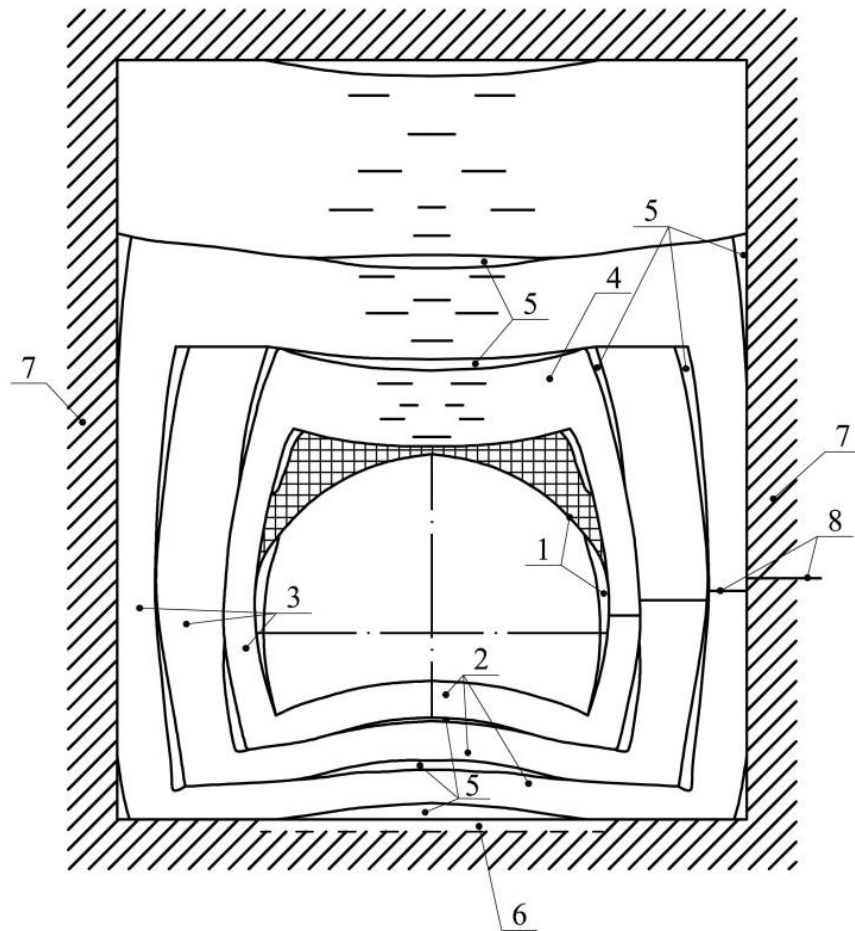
Схема деформирования пород приконтурного слоя и образования зон разрушения: 1 - металлическая арочная податливая крепь; 2 – породы почвы; 3 – боковые породы; 4 – породы кровли; 5 – пустоты и трещины; 6 – вода; 7 – ненарушенный массив вмещающих пород; 8 – маркирующий пласт [193]
